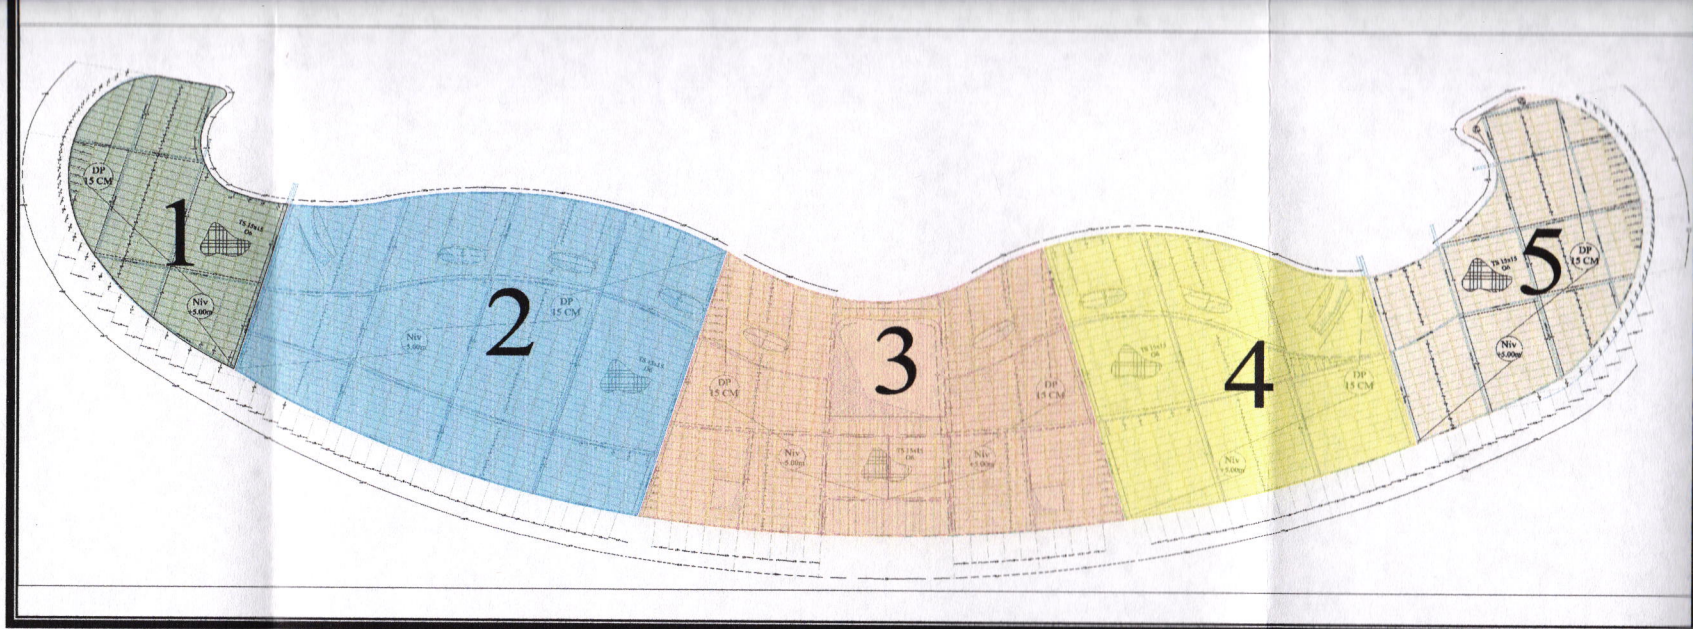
PLAN DE COFFRAGE DE CENTRE COMMERCIAL
